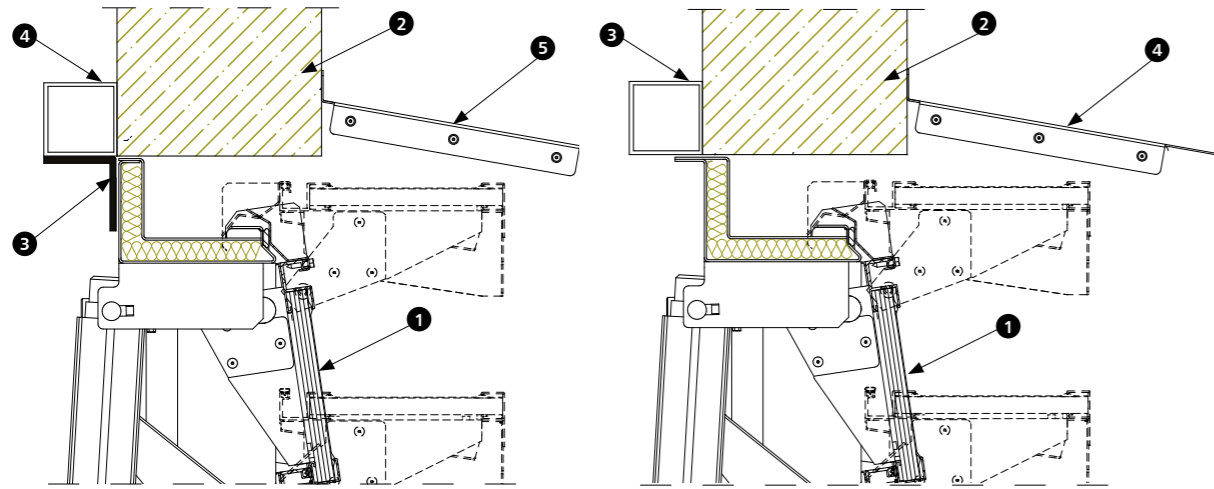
Montage des Lamellenlüfters in der Wand (Fassade) mittels einem Stahlprofil
